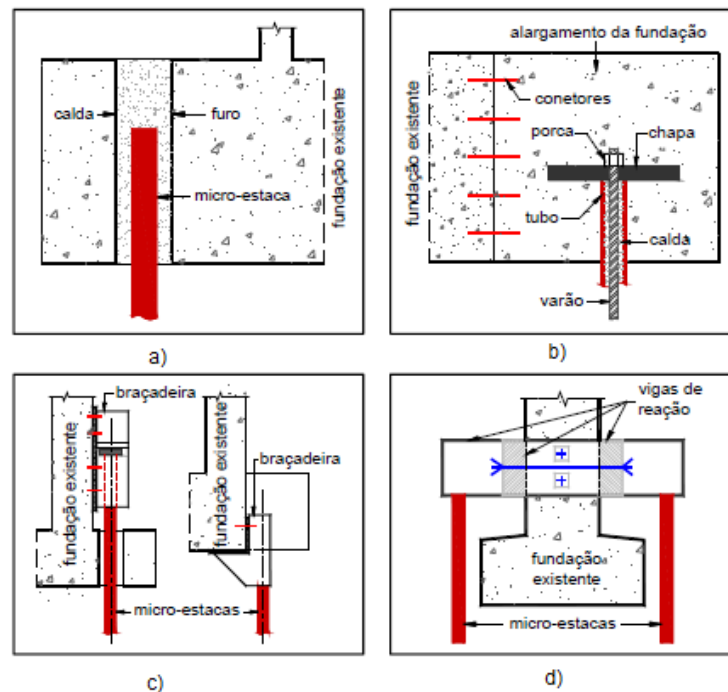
Ligações das microestacas à fundações: a) Ligação selada; b) Ligação com alargamento; c) Ligação com braçadeiras; d) Ligações com vigas de reação[15]
